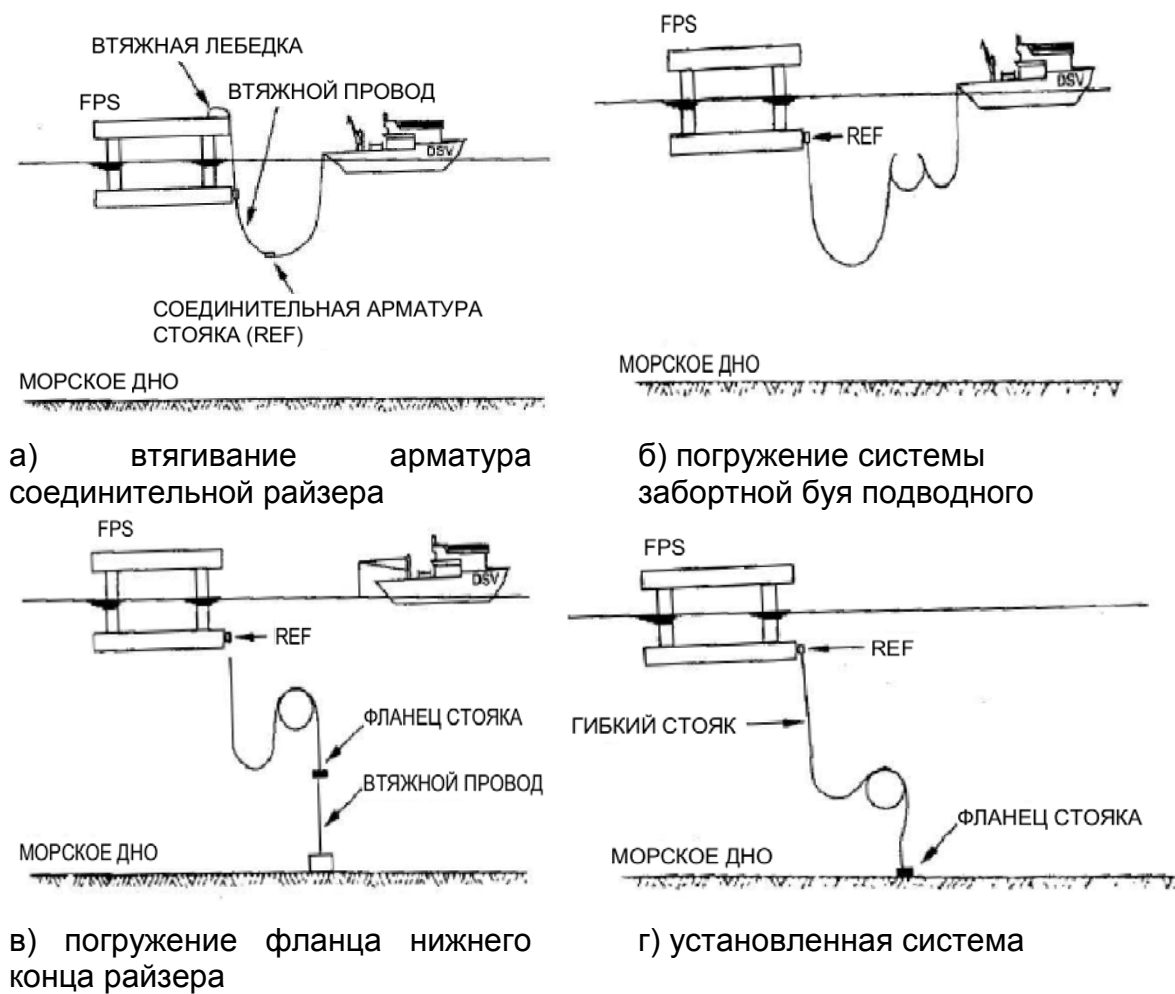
Порядок установки крутого S-стояка стандартный
